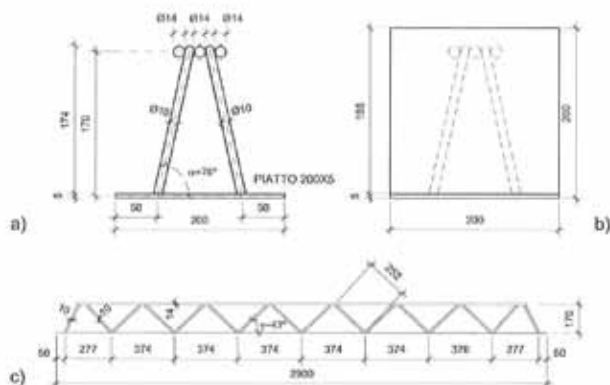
sezione trasversale del traliccio (a) e della trave mista (b). Vista laterale del traliccio (c).
